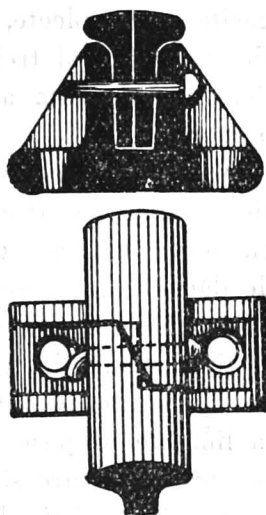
Joanta sistem Losch-Stephenson întrebuințată pe linia Stockton-Darlington
